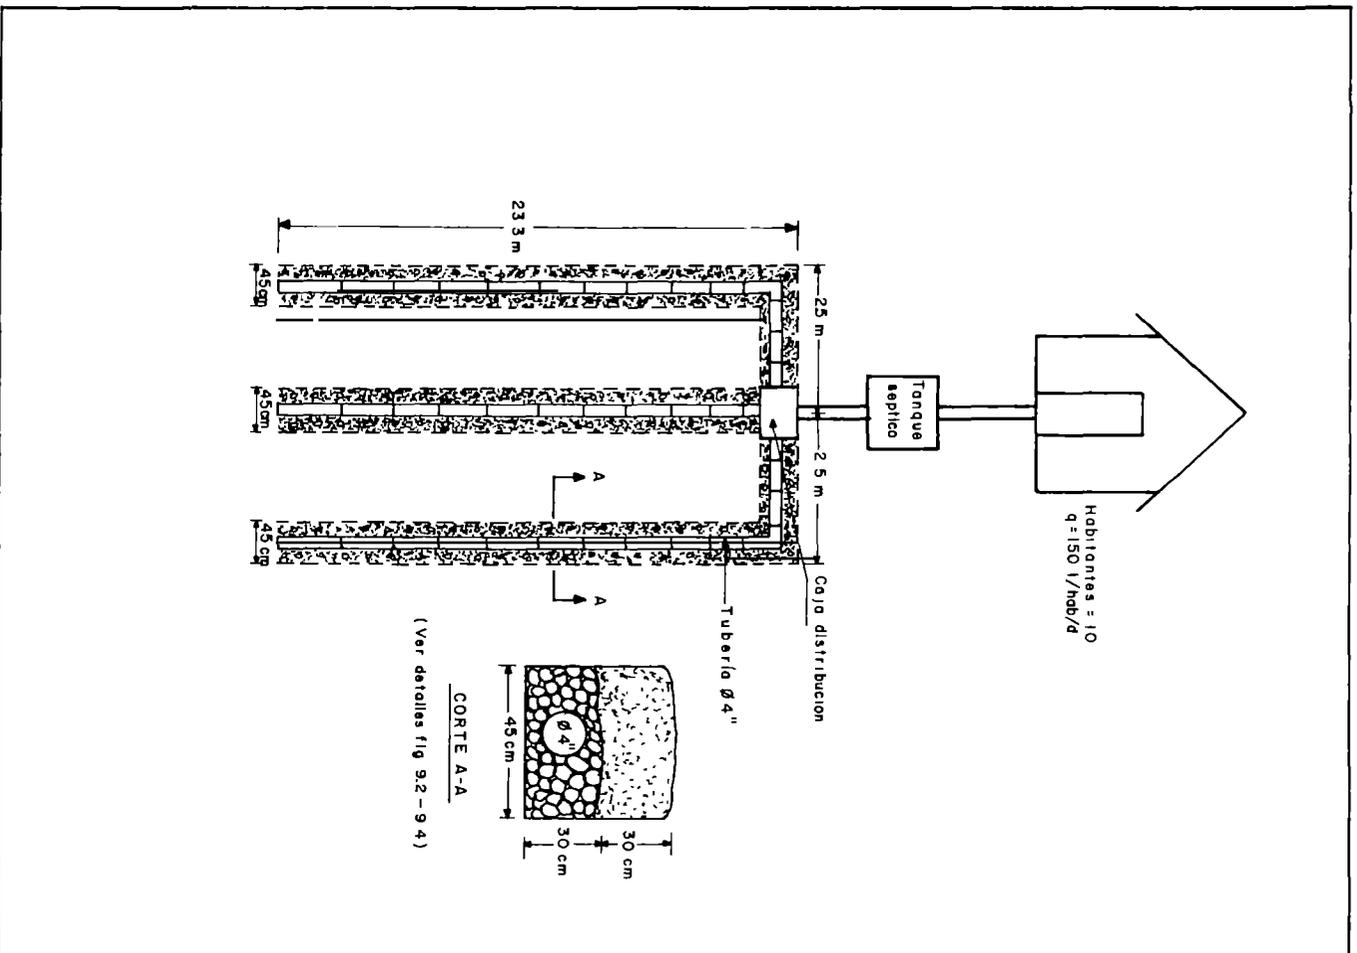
Dimensionamiento de zanjas de infiltración.
